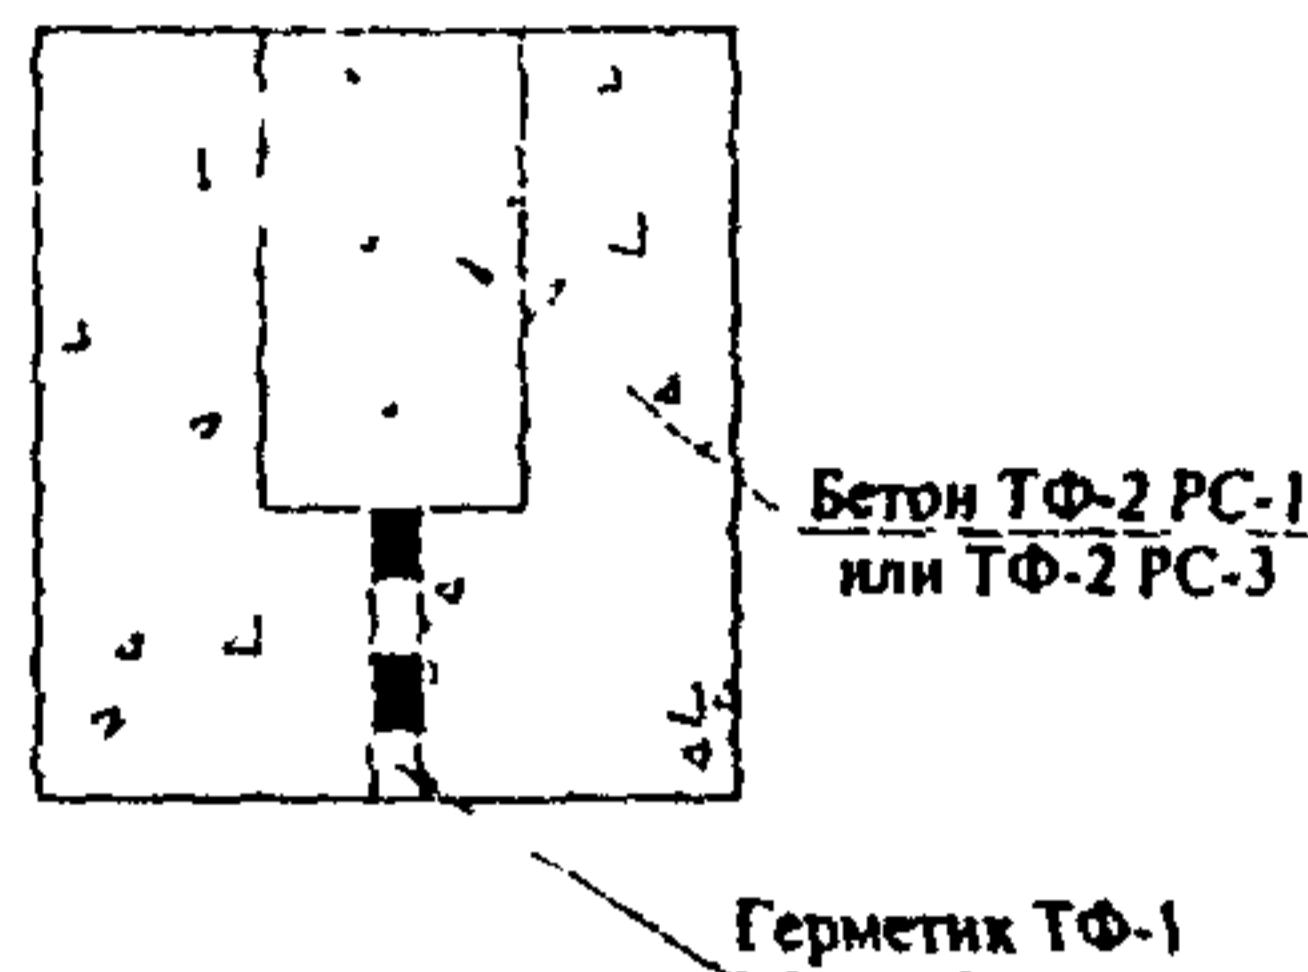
Заделка трещин в бетонных и железобетонных конструкциях
